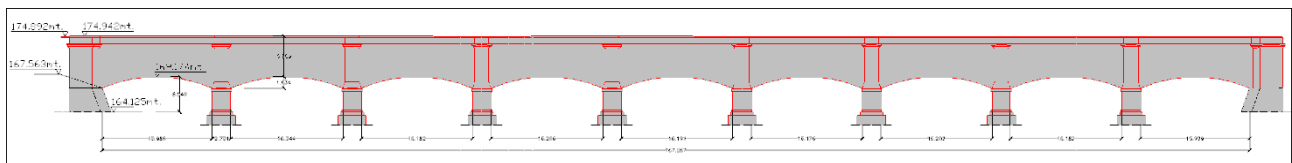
Prospetto di rilievo del ponte canale Cavour.
